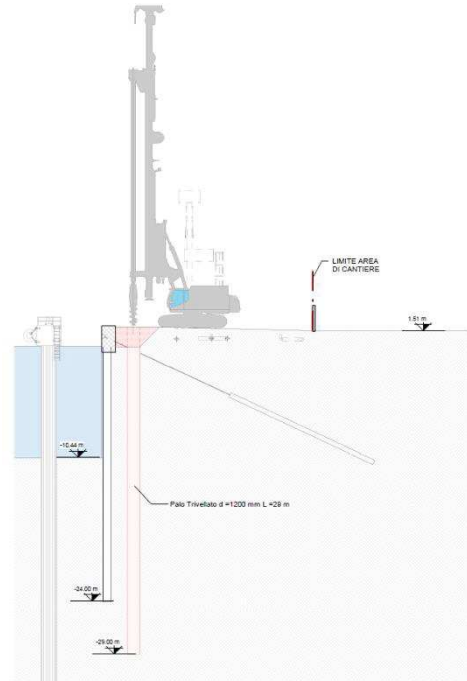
Sezione con indicazione della posizione dei pali di progetto.
